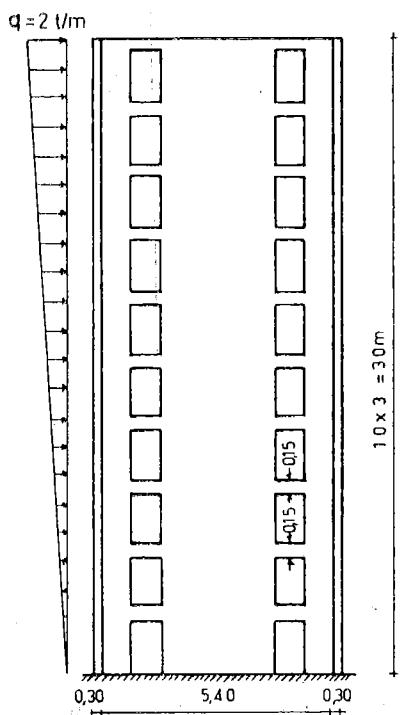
'de plan, kesit ve yükleri verilen iki sıra boşluklu ve flanşlı betonarme çekirdeğin statik çözümü istenmektedir.
